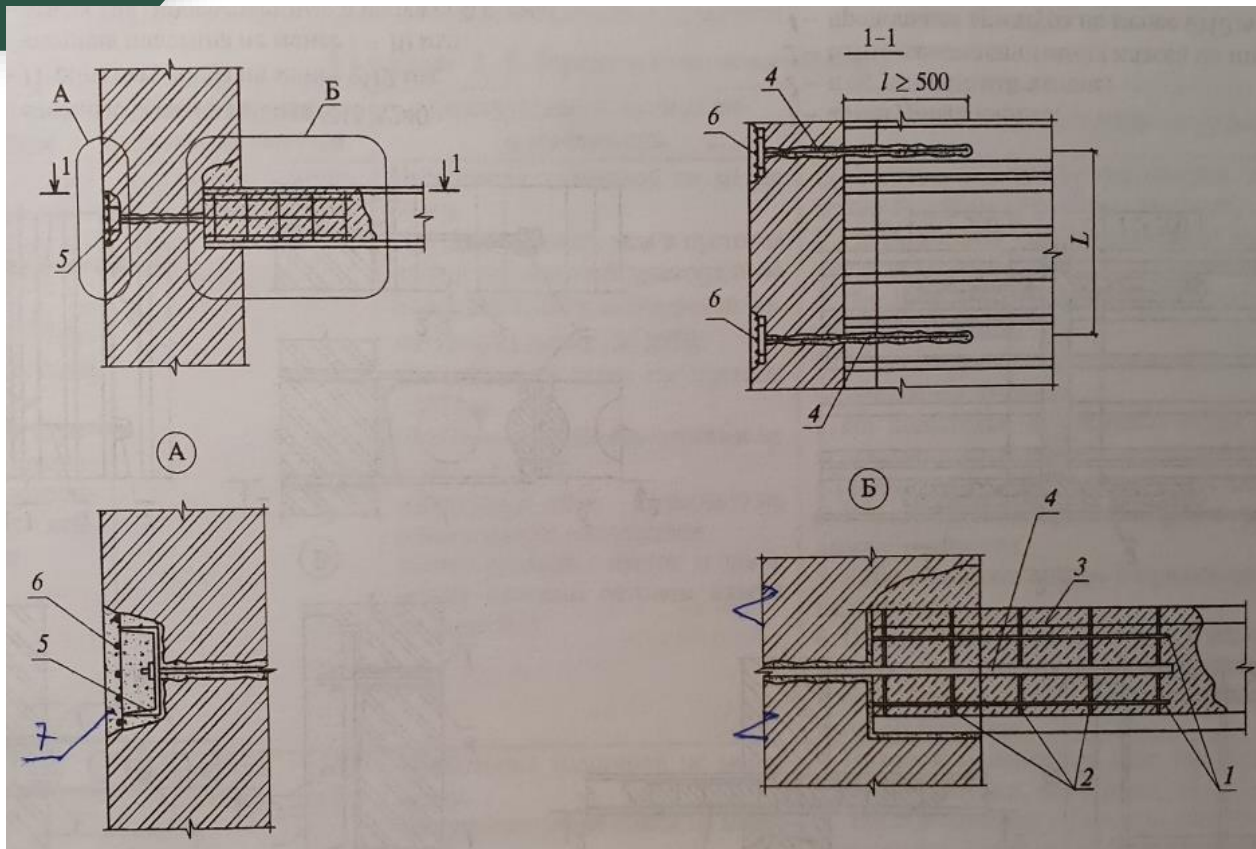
Схемы к оценке связей кирпичных стен и перекрытий и покрытий зданий
